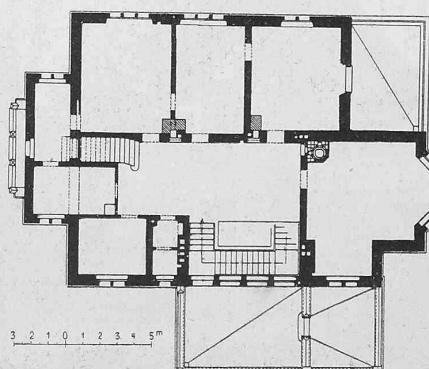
Grundriss vom Erdgeschoss. — Masstab 1 : 400. — Abb. 5. Grundriss vom ersten Obergeschoss.
